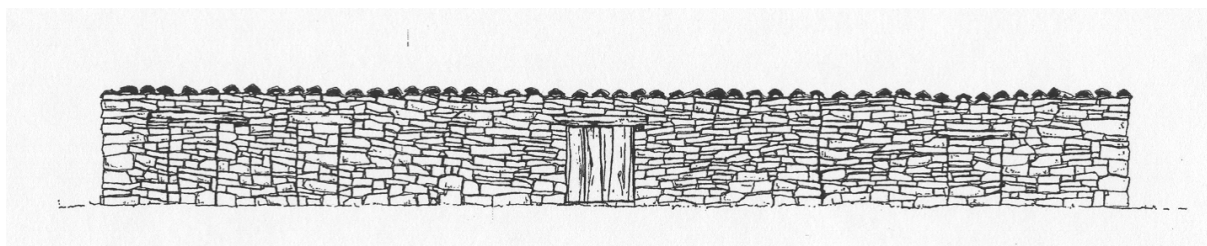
Parideras en Herrería (Guadalajara). Alzado norte
